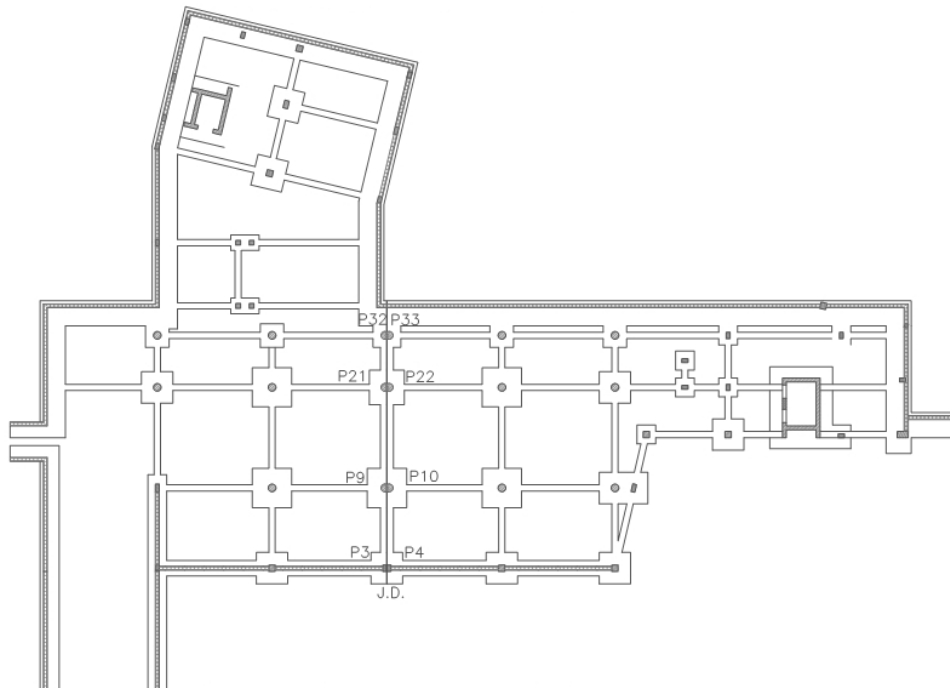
Sapatas, pilares, vigas de fundação e muros de suporte
